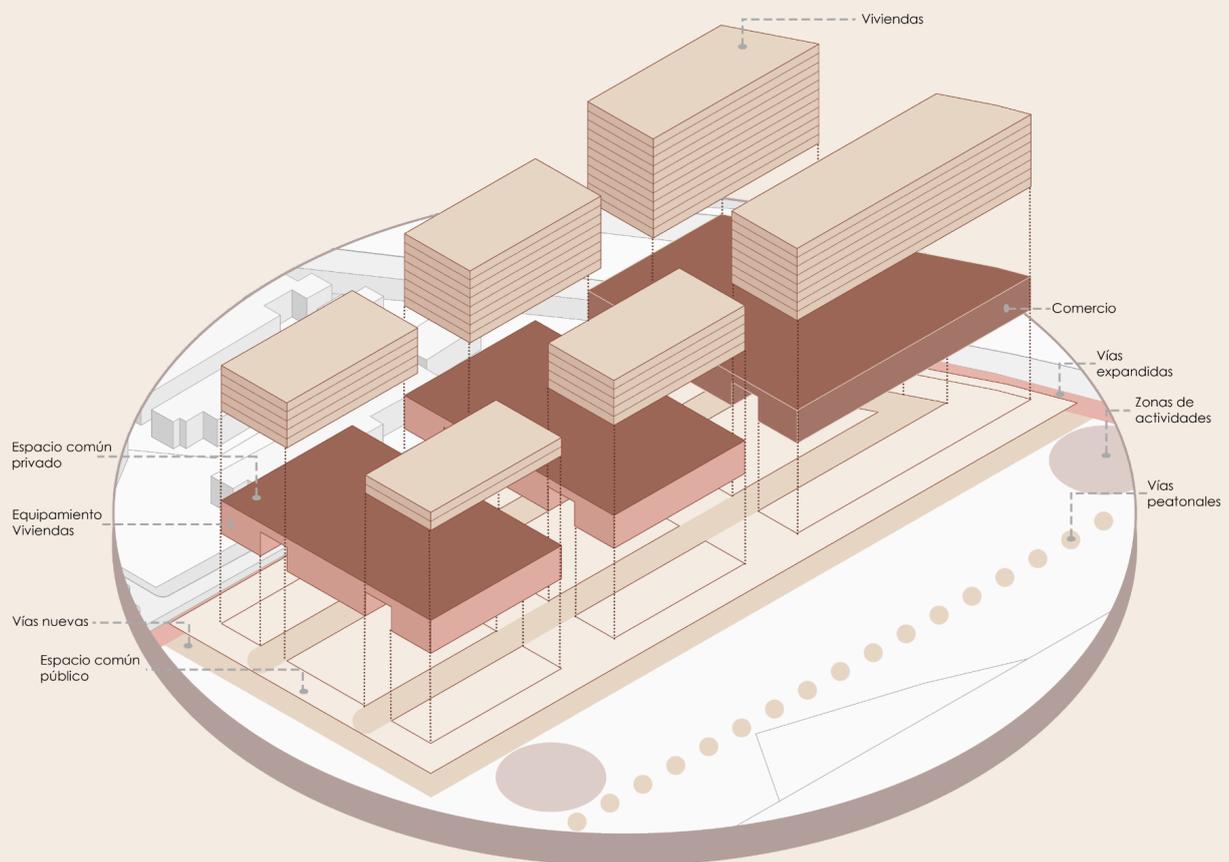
Axonométrica explotada de las partes que componen el proyecto (Fuente elaboración propia)
